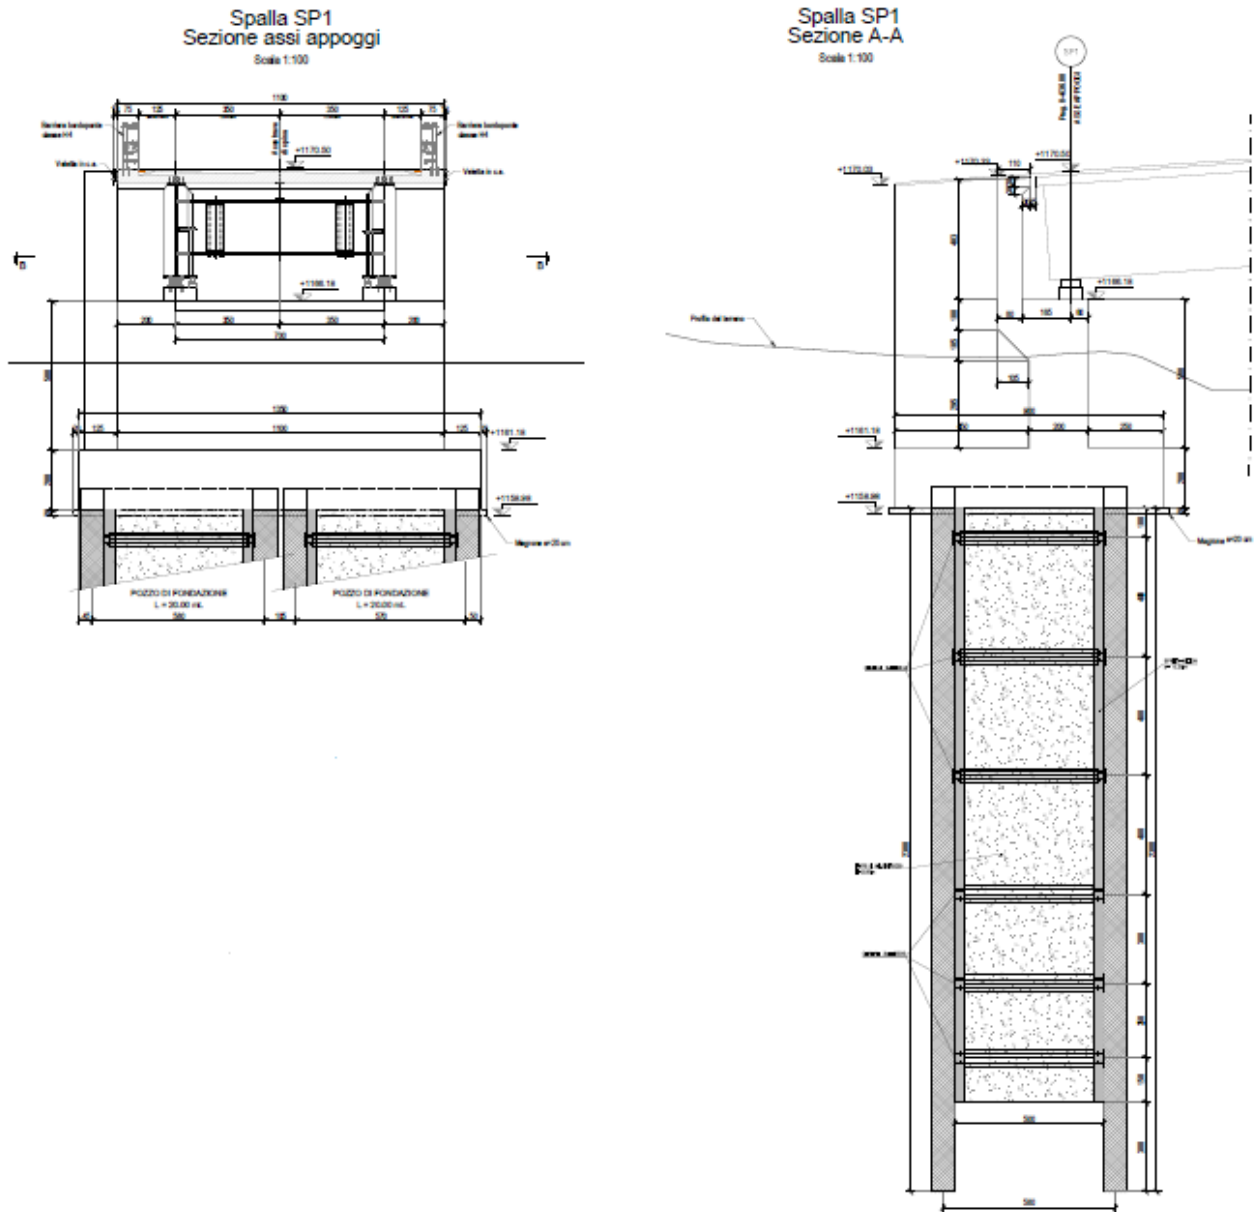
Ponte Bigontina - Carpenteria spalla 1
